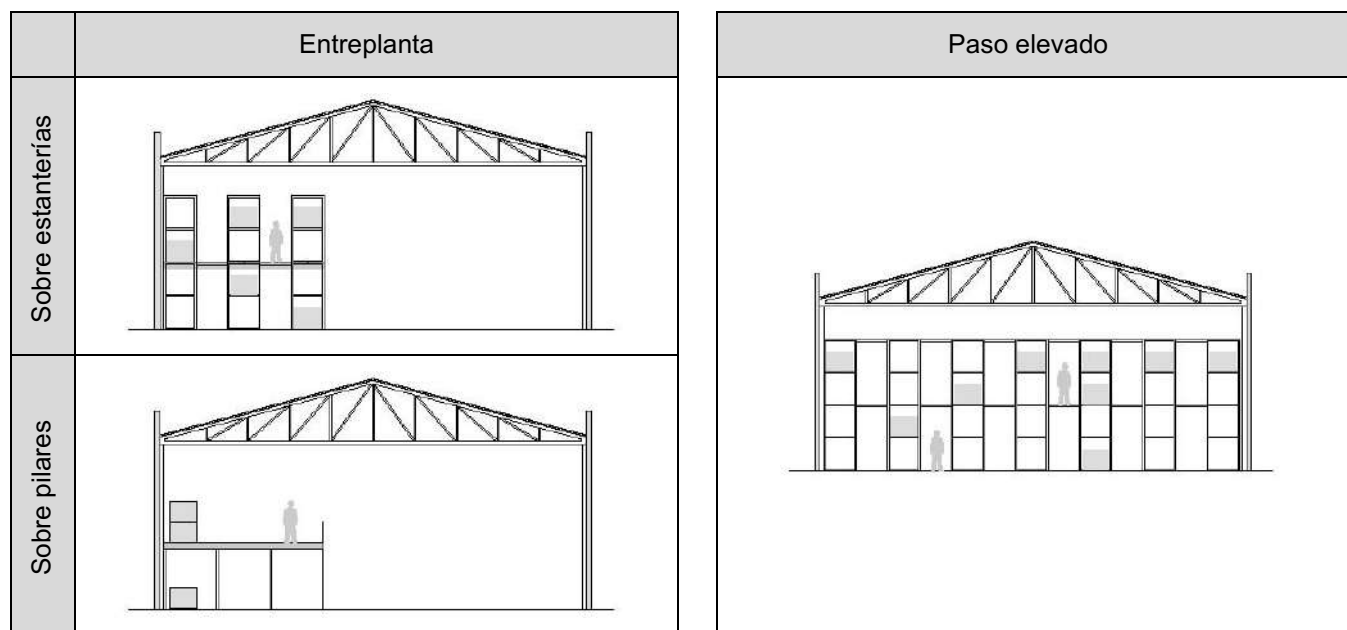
Clasificación de los pasos elevados y entreplantas
